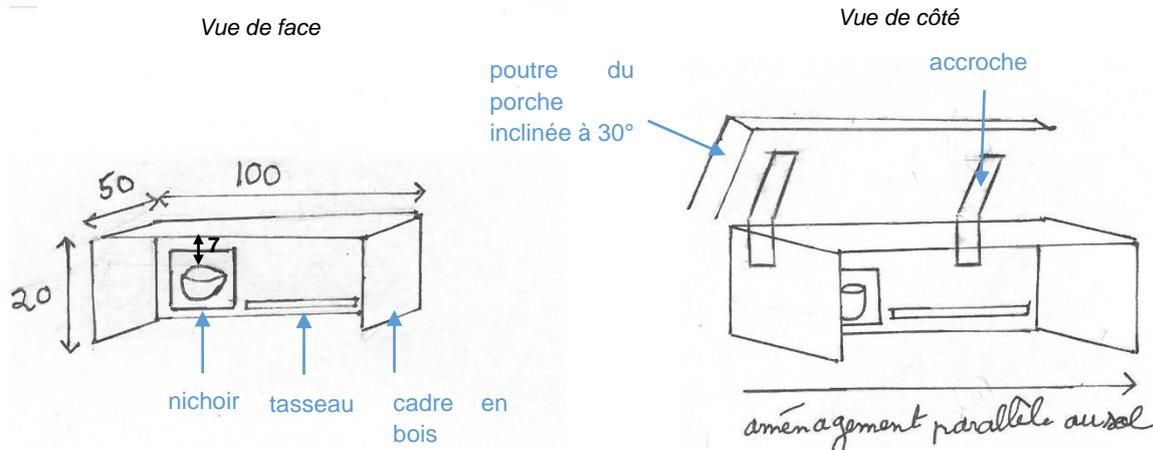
AMENAGEMENT POUR HIRONDELLE RUSTIQUE A ACCROCHER SUR POUTRE
